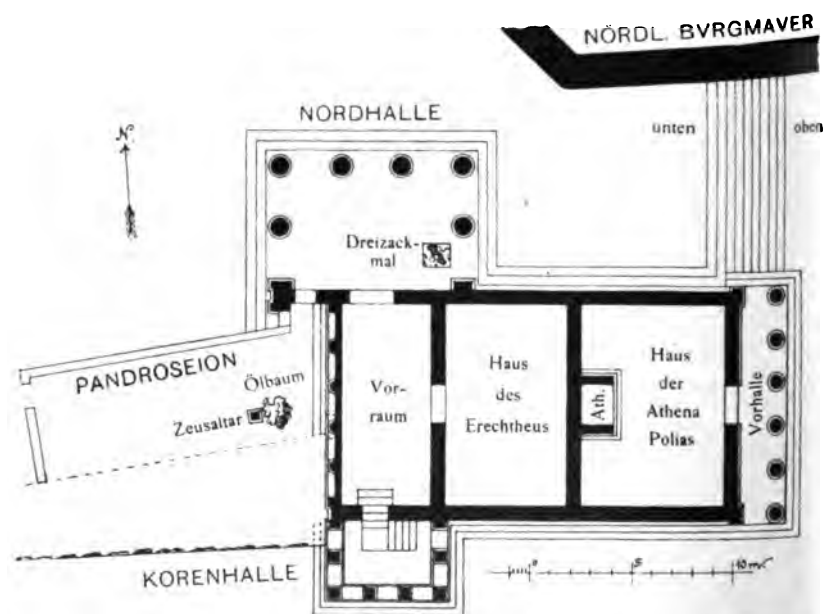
(64). Grundriss des Erechtheion.
